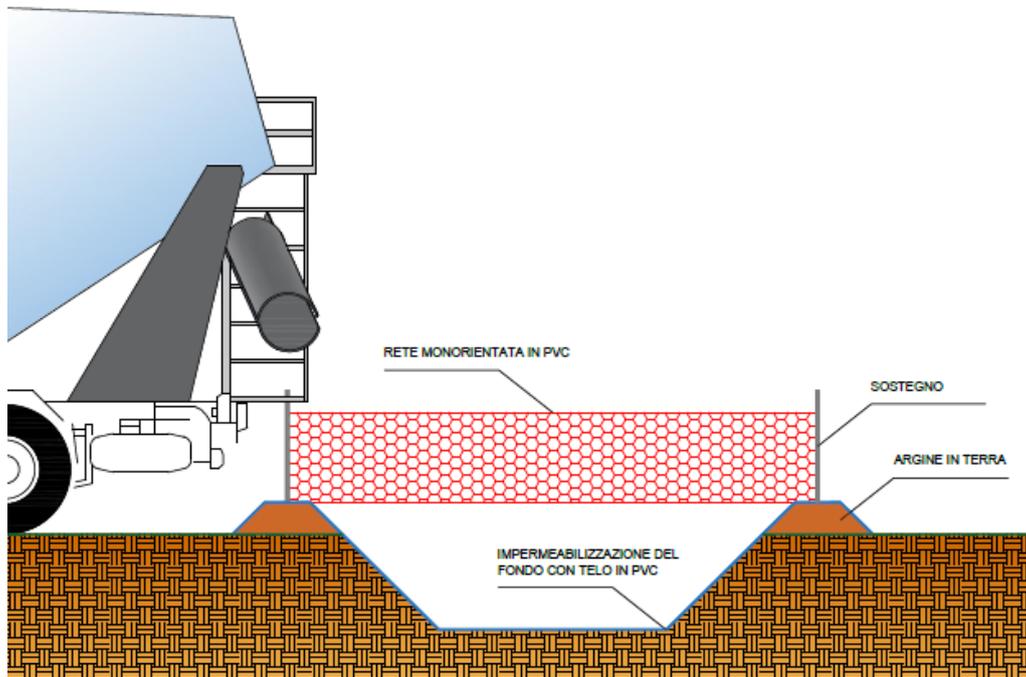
Sezione tipo vasca di lavaggio canale autobetoniera
